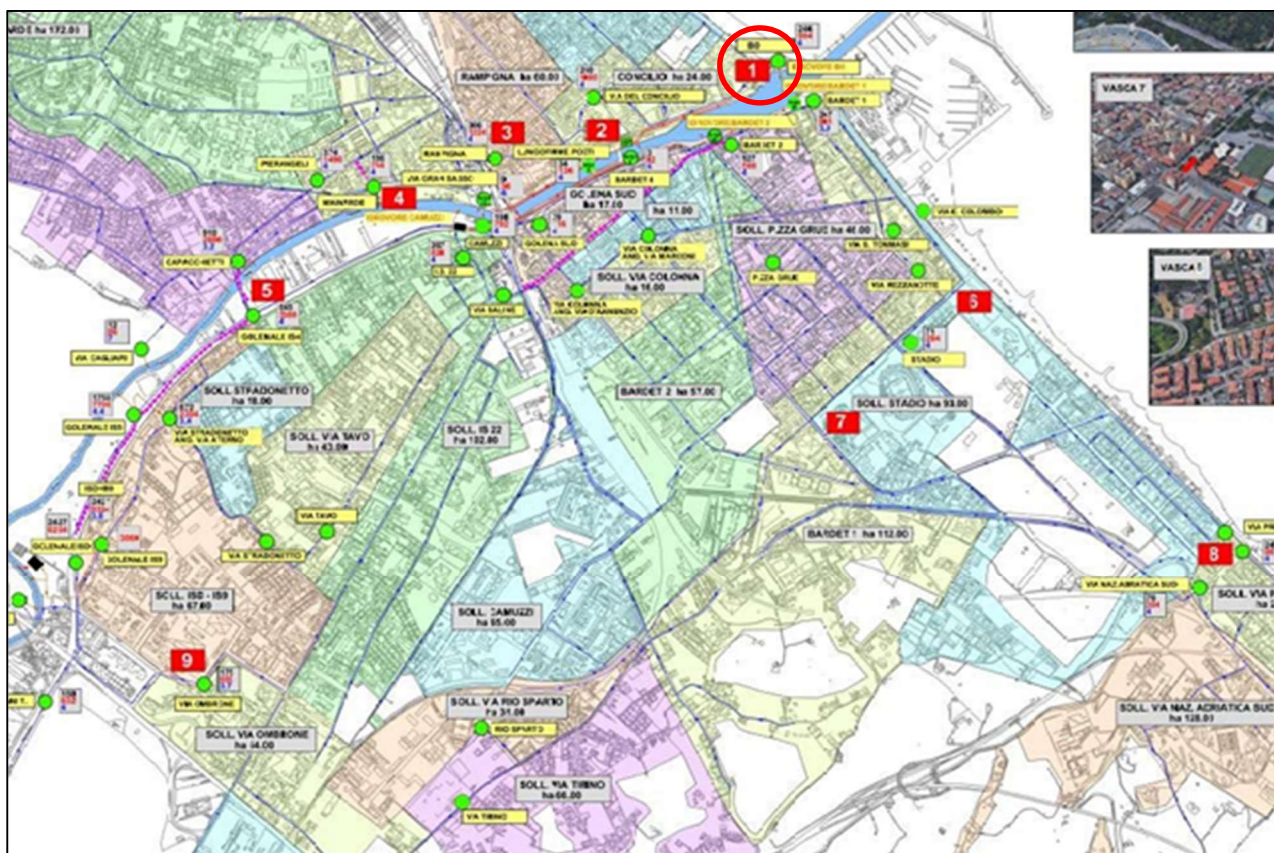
Stralcio Tav. 08.G.02 –Planimetria Generale Stato di Progetto
